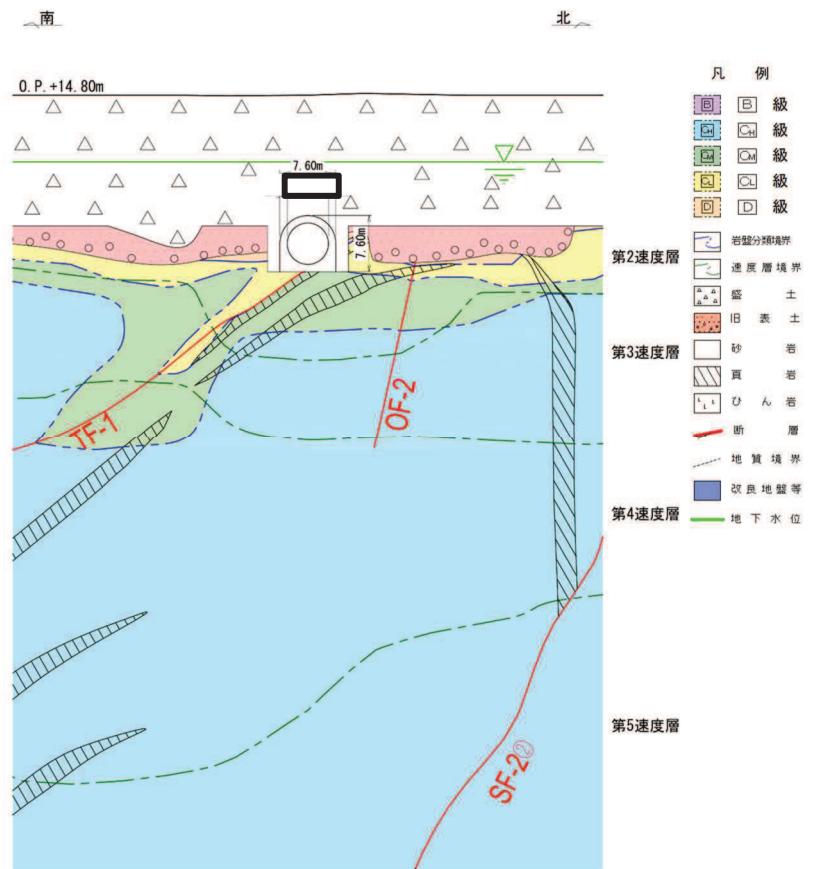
排気筒連絡ダクト（土砂部）評価対象断面図（断面②）
